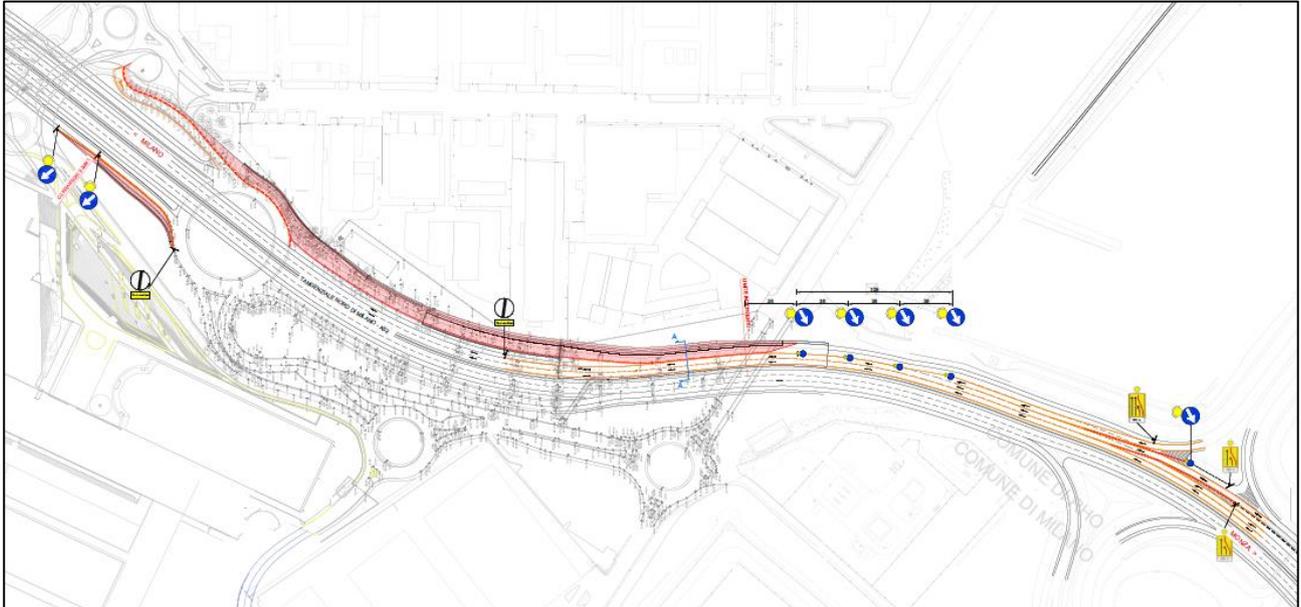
CANTIERE A52 NORD: ipotesi di fase 2
